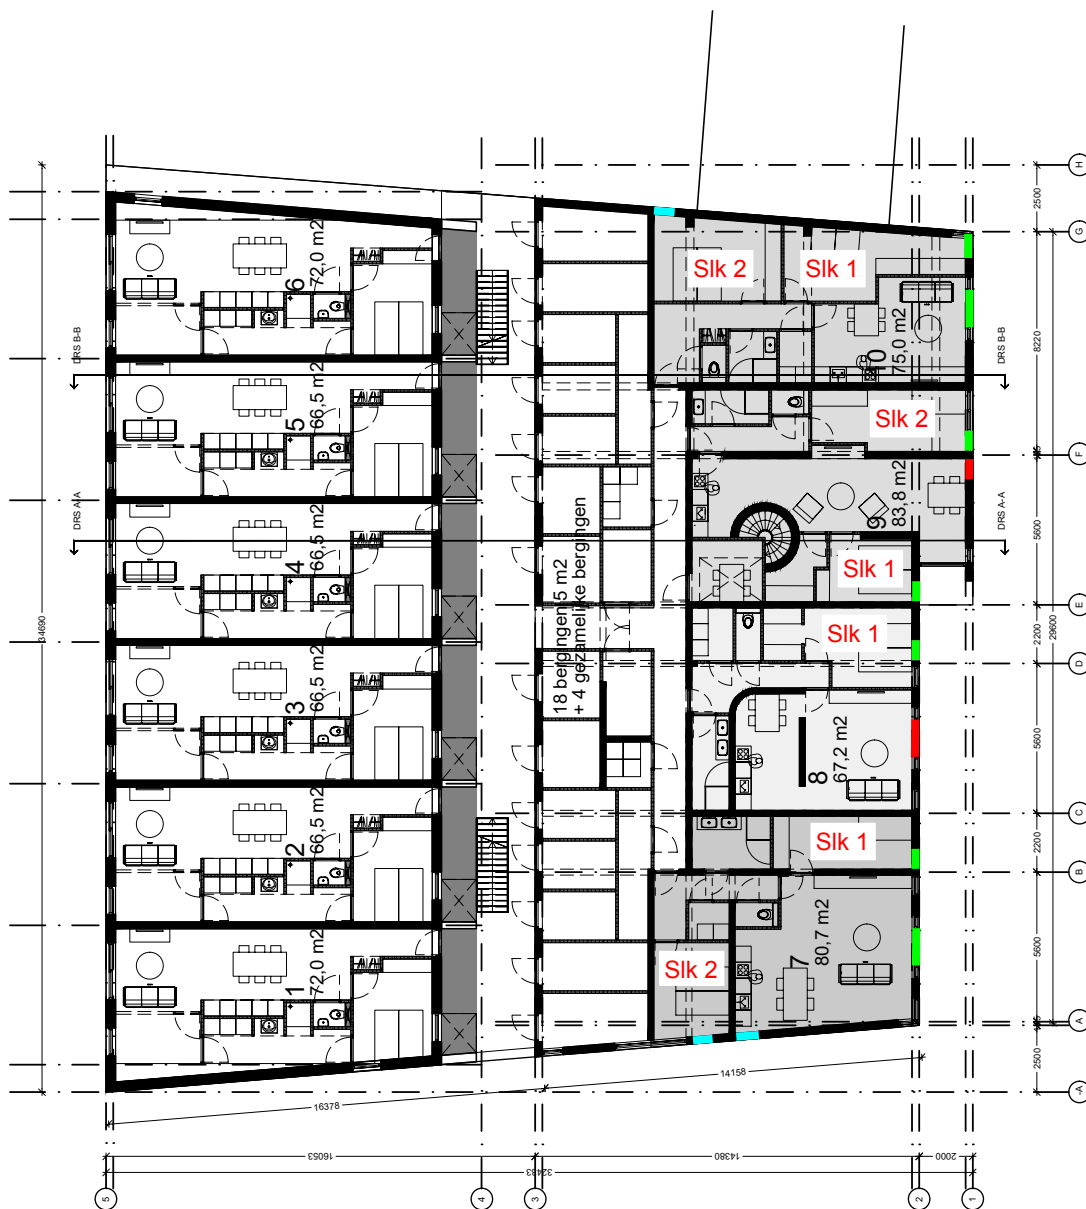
plattegrond begane grond met overzicht ventilatievoorzieningen (binnenniveau 38 dB)
